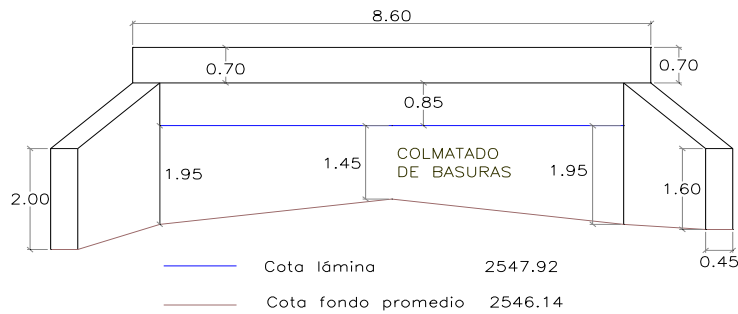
Dimensiones Alcantarilla contigua al Cementerio Jardines de Paz (Estructura E1) (Fuente: EAAB-ESP)
